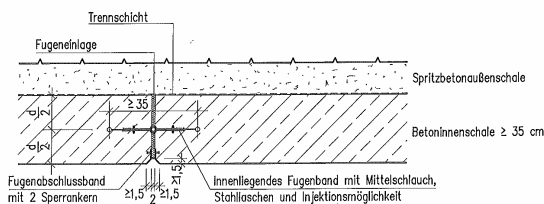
Raumbfuge, Tunnel geschlossene Bauweise (Spritzbetonbauweise)
